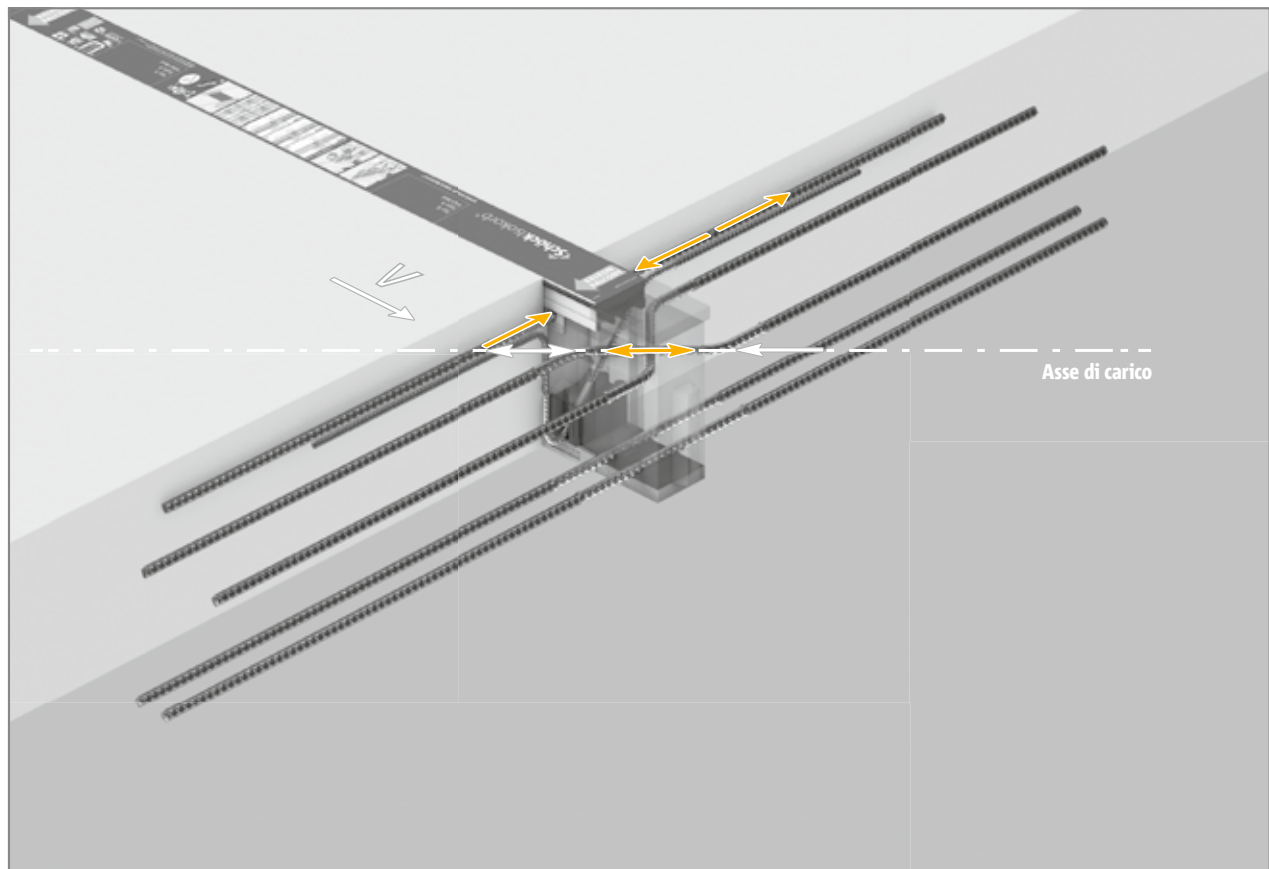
Schöck Isokorb® T tipo KL e T tipo HP: trasmissione della forza di taglio orizzontale.
